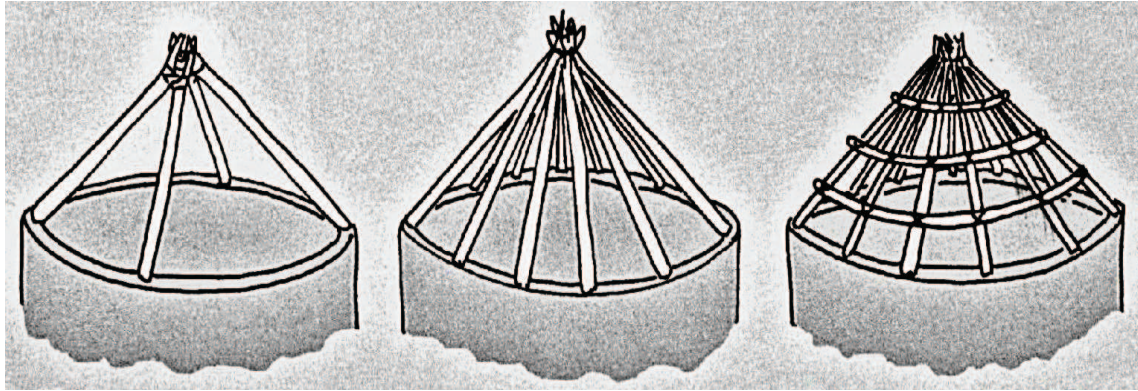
Dachkonstruktion einer Lehmhütte mit kreisförmigem Grundriss: Die Unterkonstruktion liegt direkt auf dem Lehmmauerwerk auf und wird kegelförmig ausgeführt. In die Hauptkonstruktion bestehend aus vier Ästen, die mit bereits in die Mauer eingegossene Anker (auch aus Holz) verbunden sind, werden weitere Äste gelehnt. Anschließend wird das Gerüst vertikal mit Schnüren verbunden. Die Eindeckung erfolgt mit Grasbündeln. Die Dachkonstruktion eignet sich nur bei Rundhütten und ist nicht begehbar, sondern lediglich mäßig belastbar.
